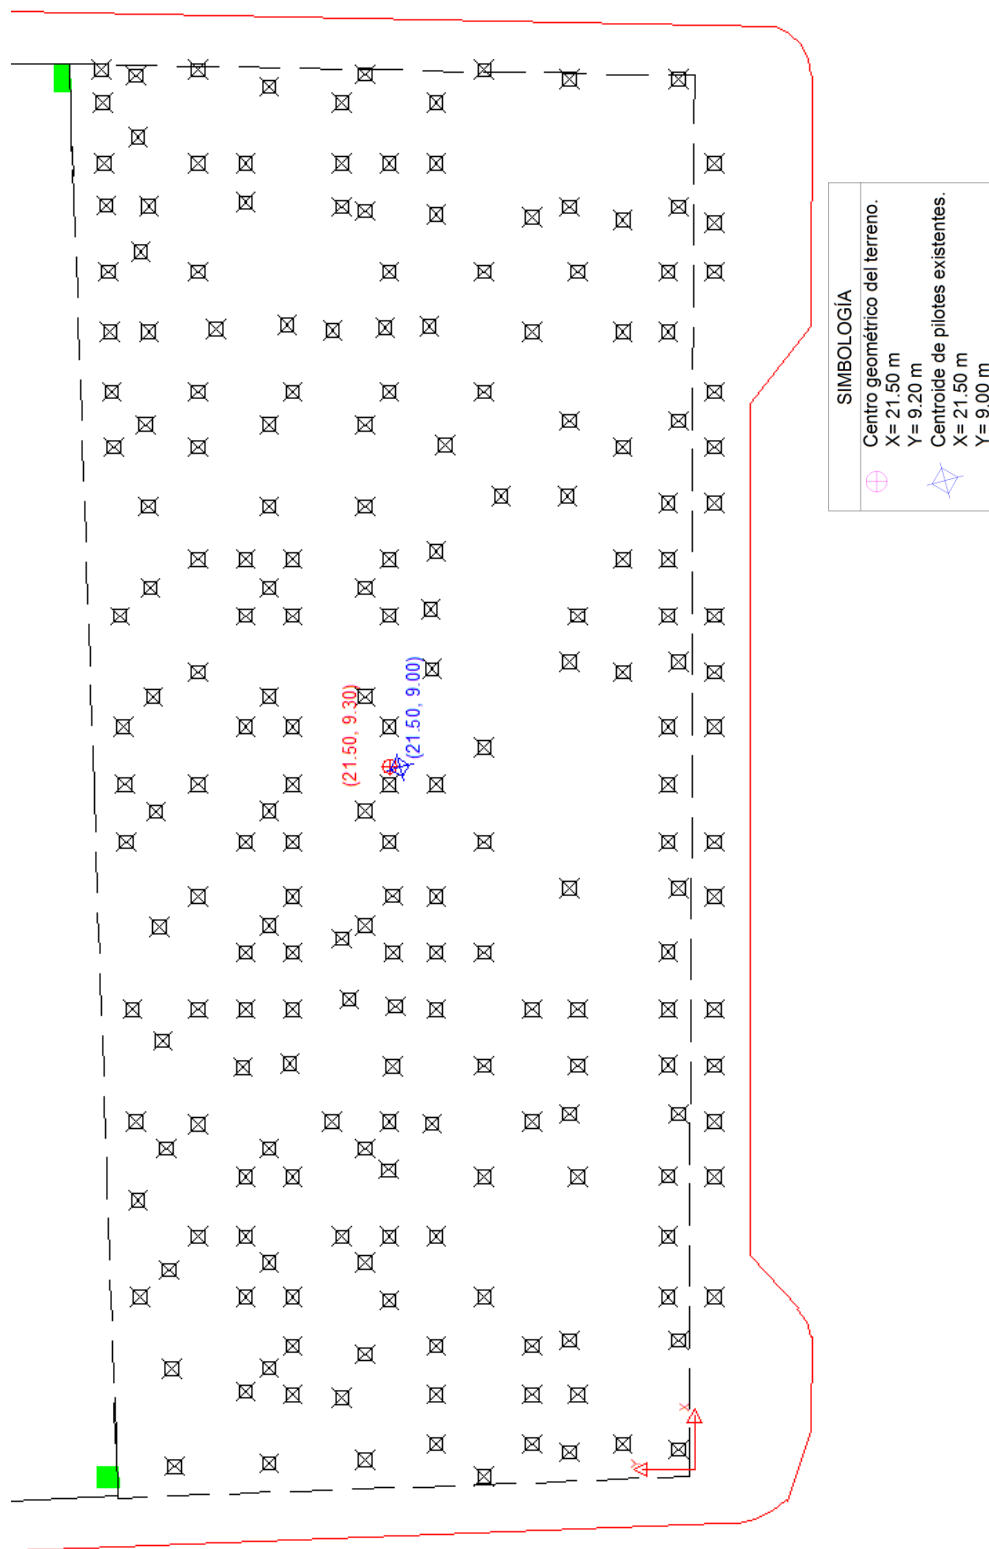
Centroide de los pilotes y centro geométrico del terreno.
